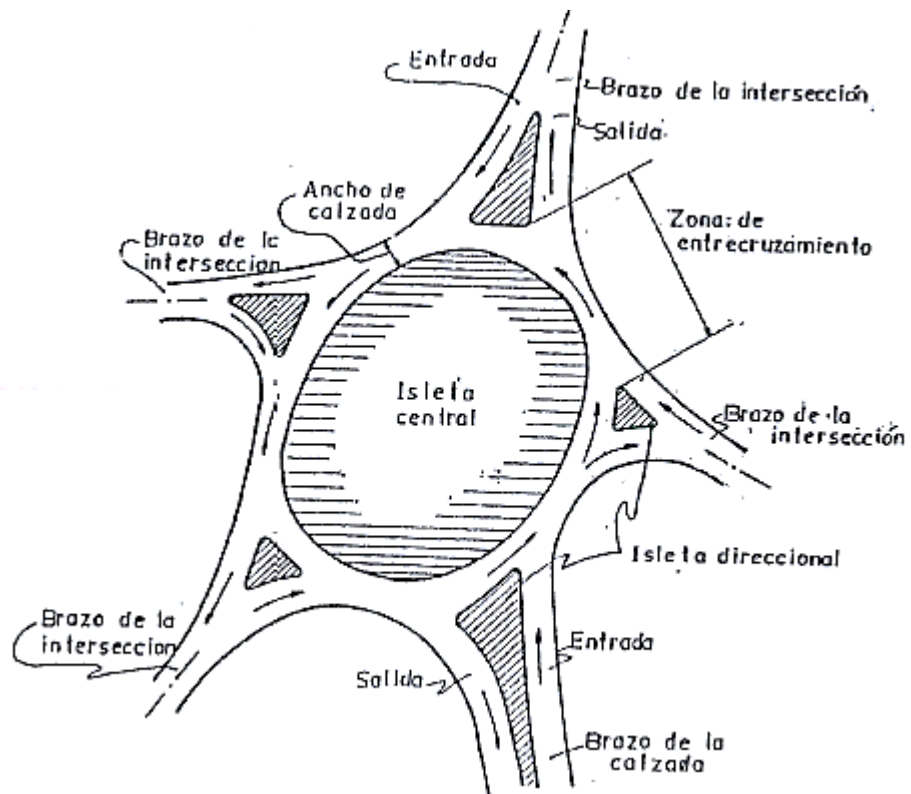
Intersección tipo rotonda
